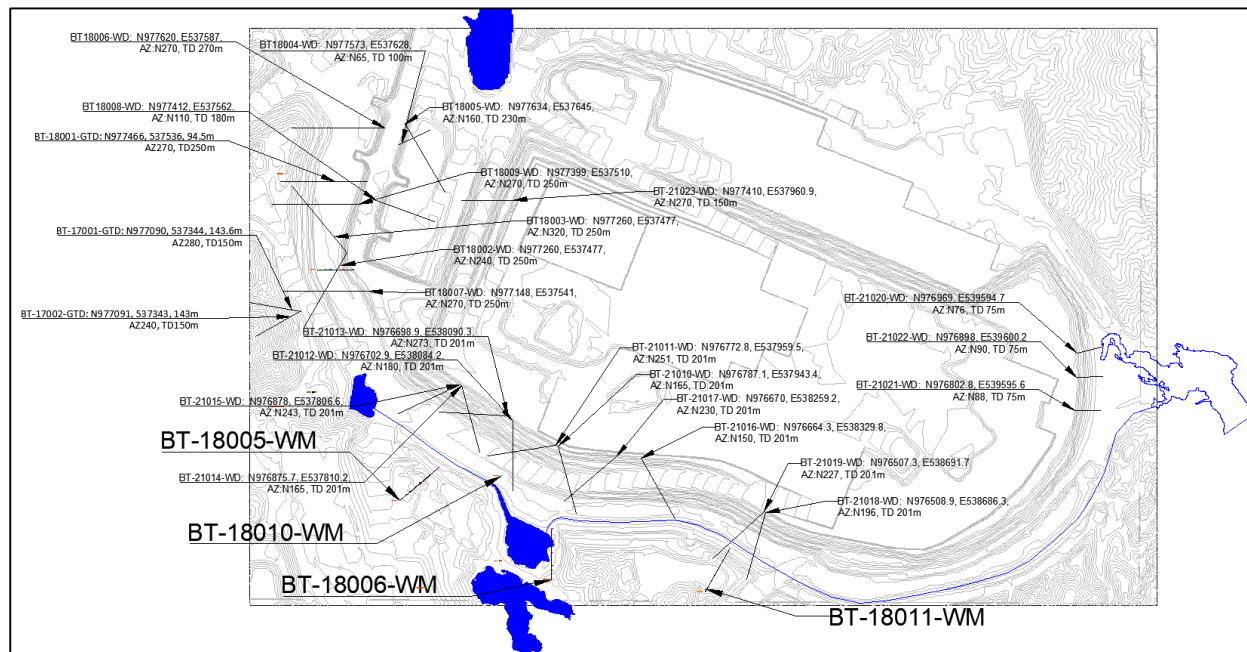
Drenajes horizontales en el tajo Botija – April 2022.
